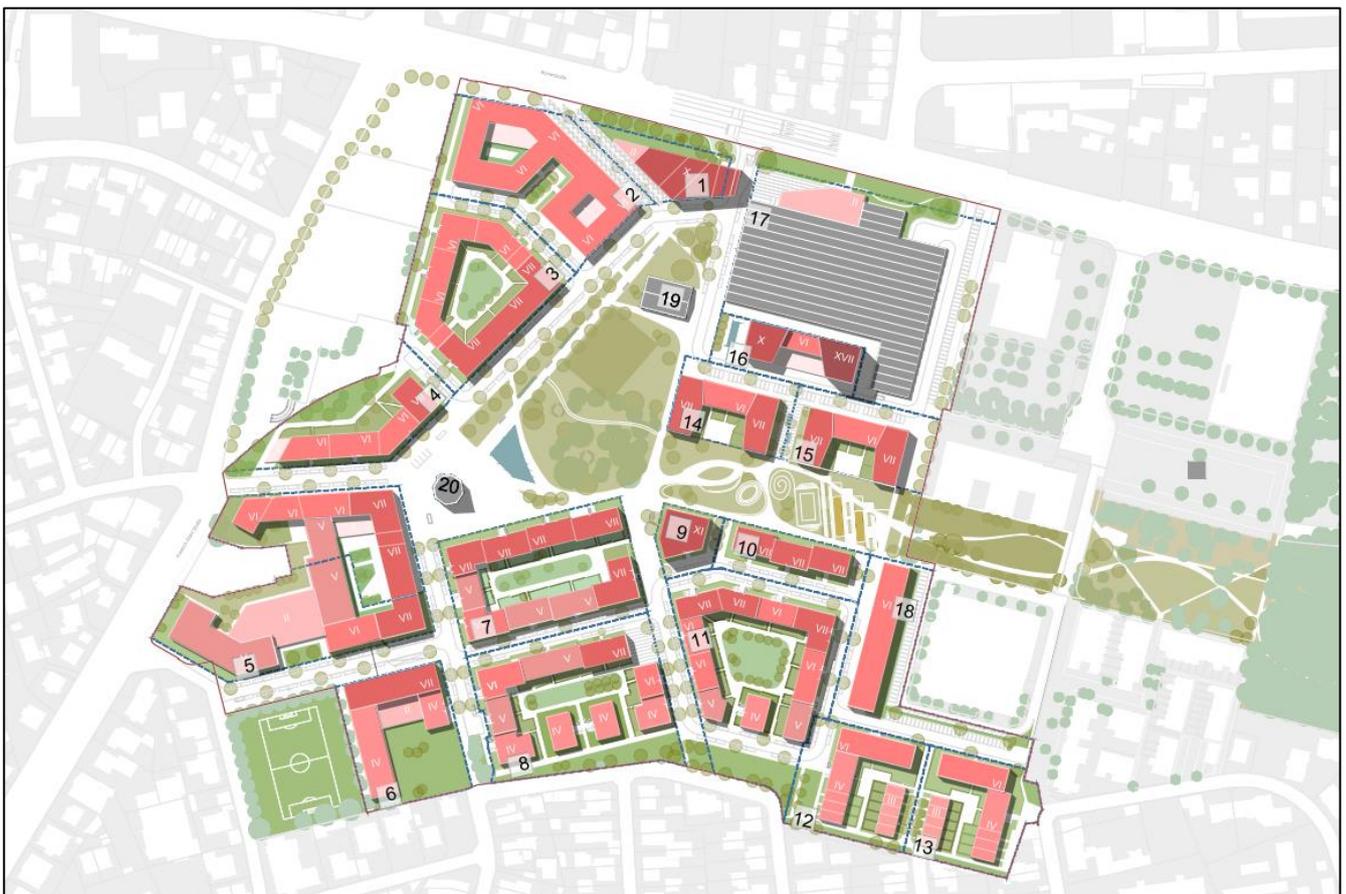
Lageplan – INquartier Ingolstadt (Quelle: kister scheithauer gross architekten und stadtplaner)
